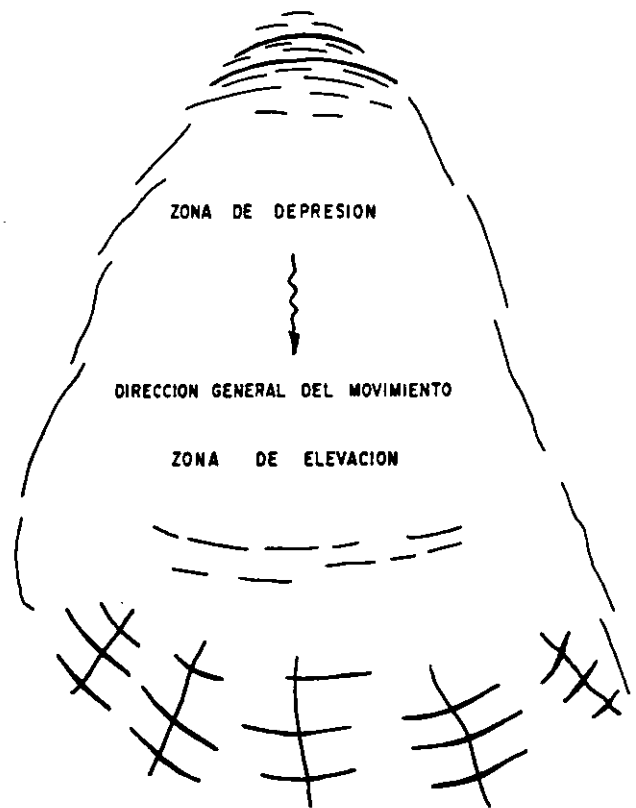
Planta típica de agrietamiento en un deslizamiento de tierra (Ref. 8).
